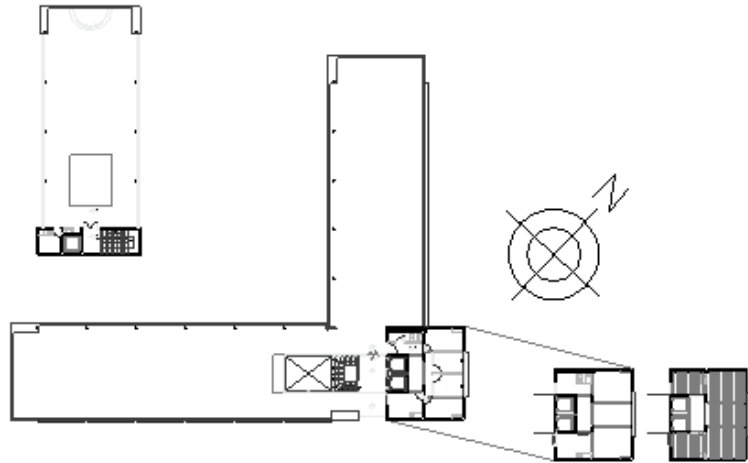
Planta Piso 6 y 7 – Oficinas – Nivel +19,80 hasta +22,55
